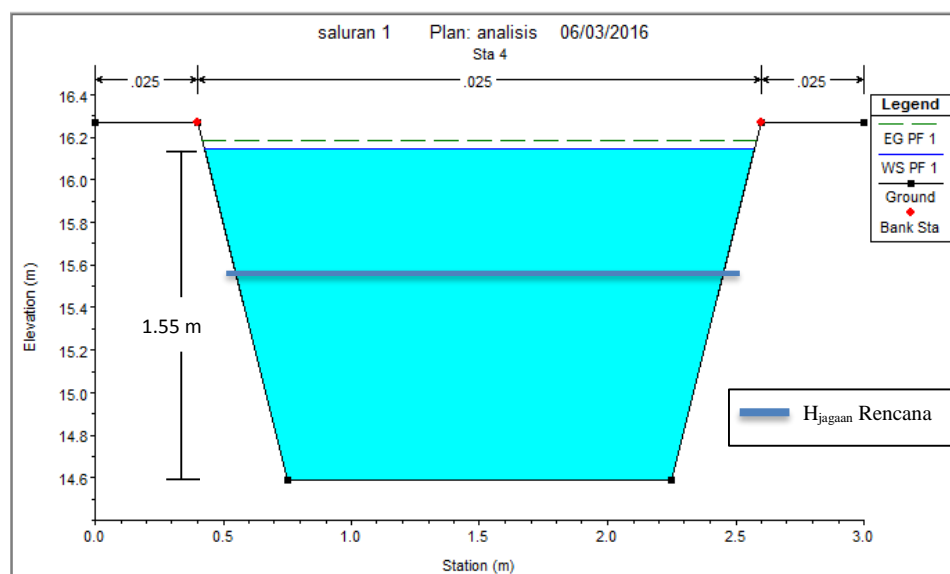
Cross Section* profil saluran Sta.6 (J.6) pias I.
